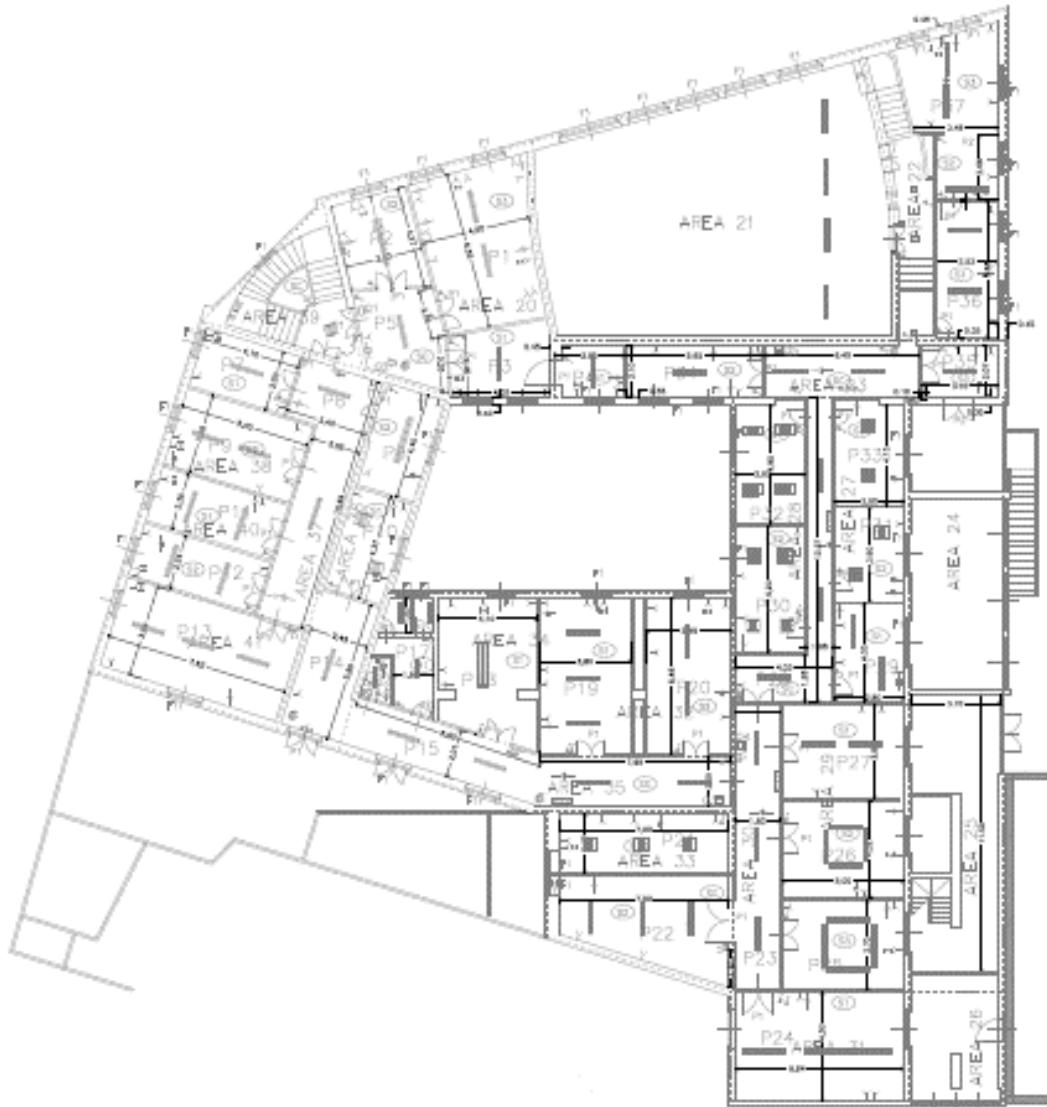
8: Rilevamento dello stato attuale in pianta. Piano Terra
